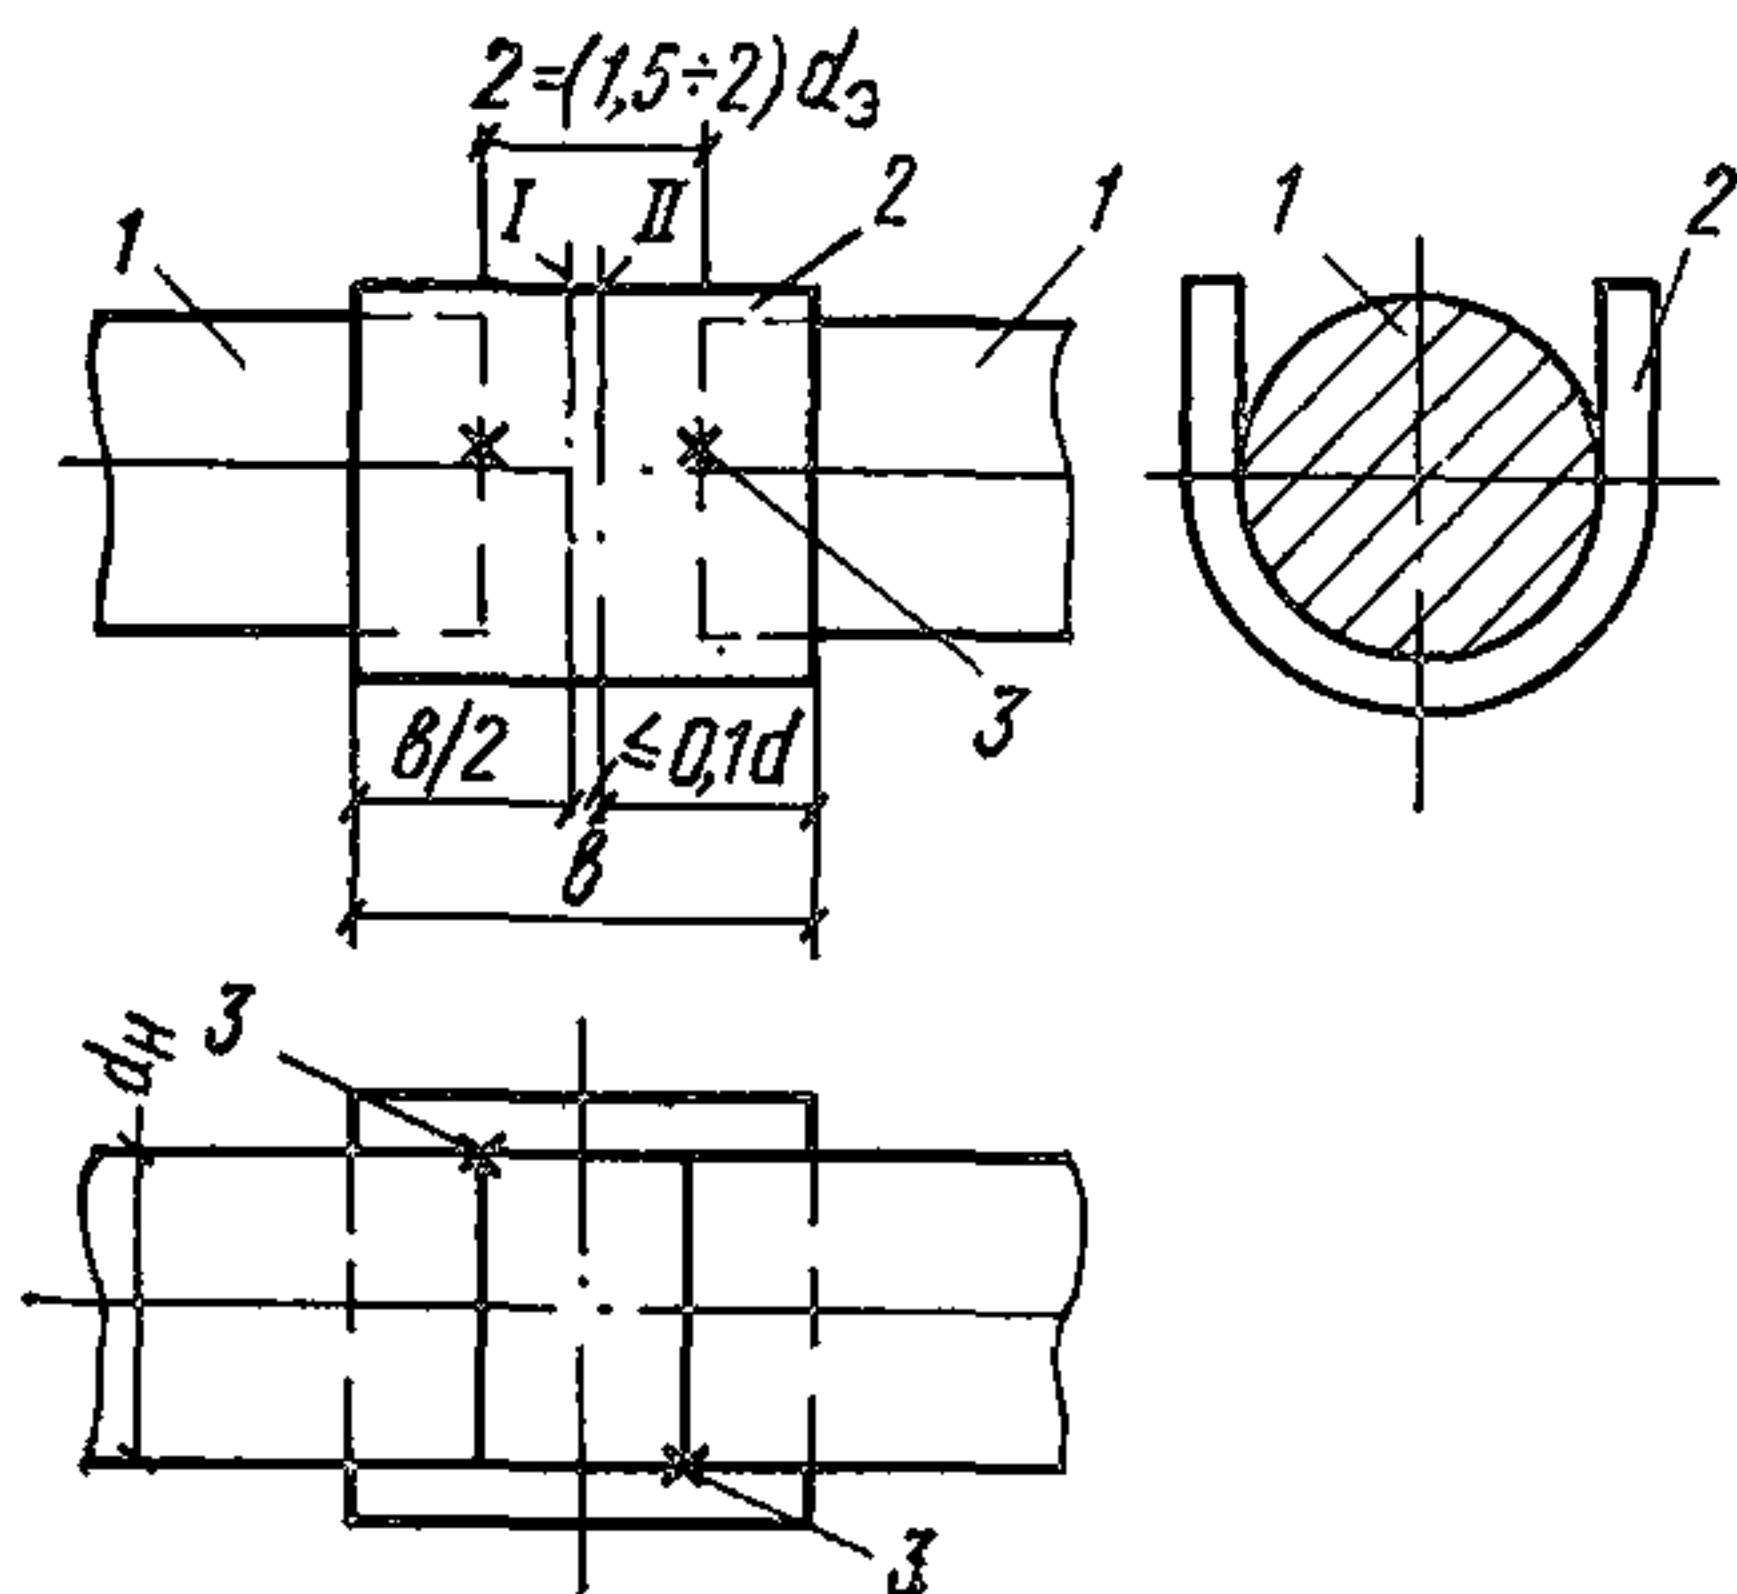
Условия сборки стыка стержней для ванный или ванно-шовной сварки
